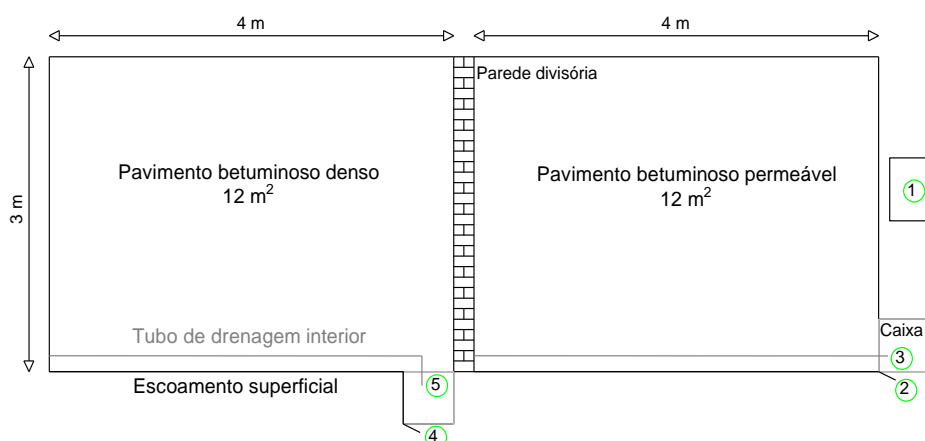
Área em planta e pontos de recolha no TE1: 1 – água da chuva; 2 – escoamento superficial do pavimento betuminoso permeável; 3 – infiltração do pavimento betuminoso permeável; 4 - escoamento superficial do pavimento betuminoso convencional; 5 – infiltração do pavimento betuminoso convencional
